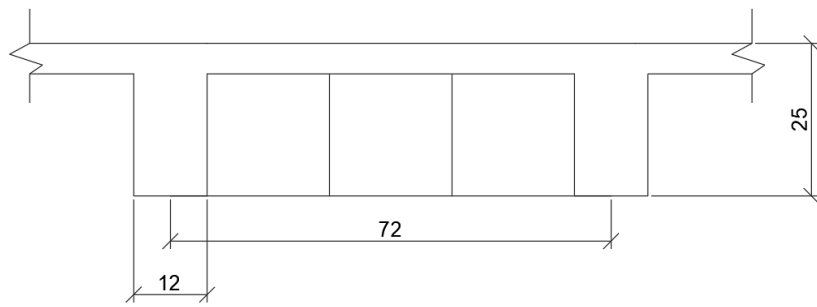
Sección tipo del forjado reticular dispuesto. Cotas en centímetros.
